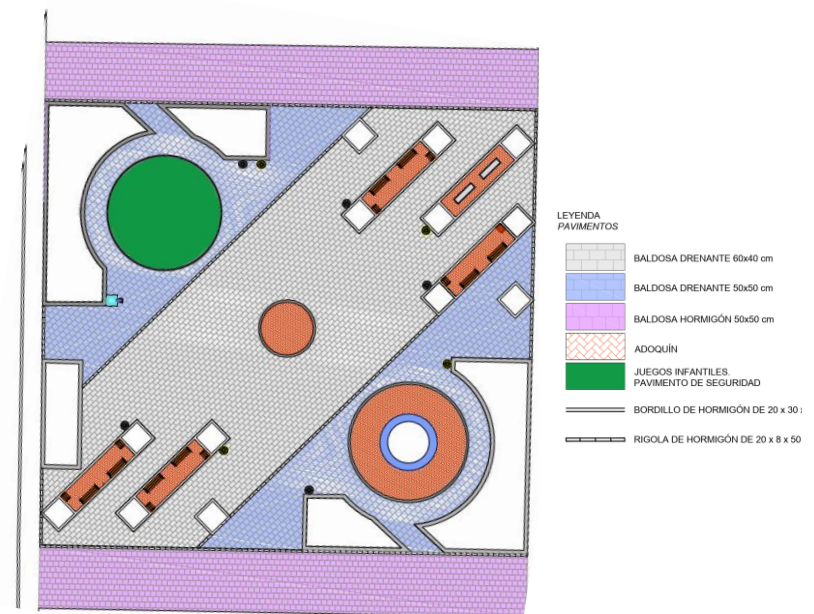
Distribución de los pavimentos en la plaza Lorenzo de la Flor.
